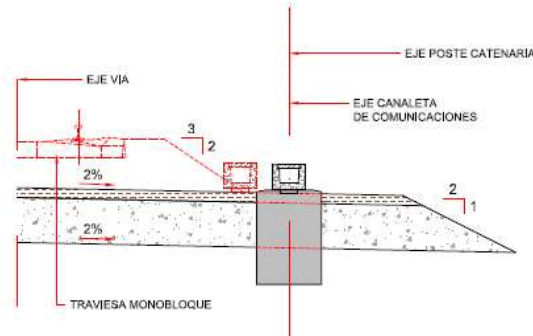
Detalle de canaleta elevada a eje de poste (Fuente: elaboración propia).
